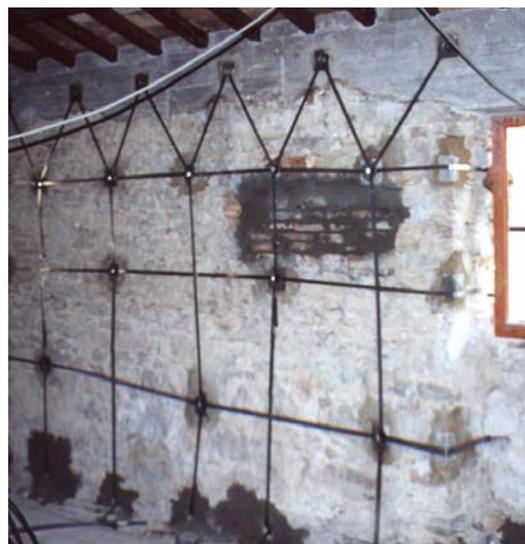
disposizione delle maglie su parete con intonaco completamente rimosso.
